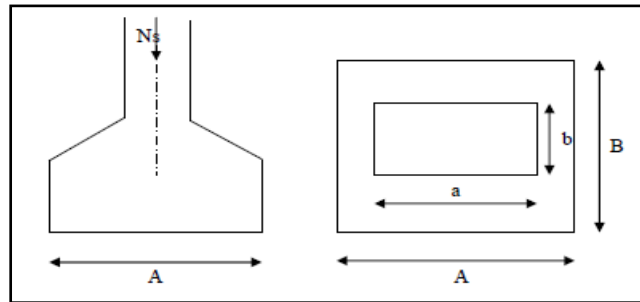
Pré-dimensionnement de la semelle isolée sous poteaux.
